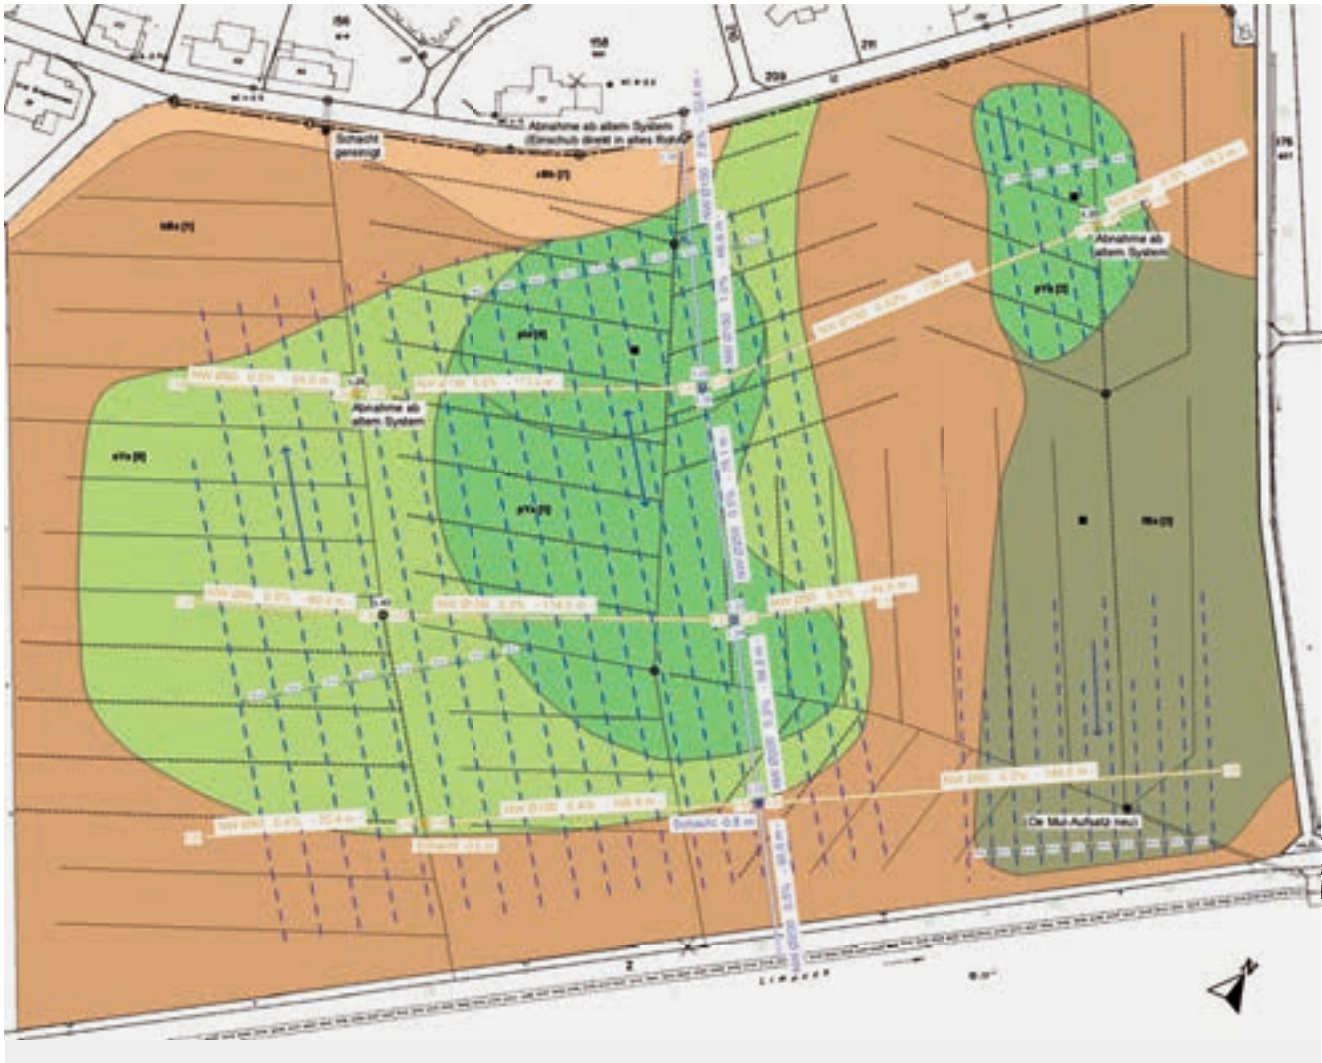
Wasserhaushaltskarte mit Ausführungsplan zur Sanierung der Entwässerung im Gebiet «Moos» in Aetingen. Grün: stauwasserbeeinflusste und stauwassergeprägte Böden; braun: normal durchlässige Böden; schwarze Vierecke: Standorte der Bodenprofile; blau gestrichelte Linien: neue Drainageleitungen; beige Linien: neue Sammelleitungen; schwarze Linien: bestehende, funktionierende Drainagen; schwarze, durchgestrichene Linien: nicht mehr funktionstüchtige alte Drainagen. Emch, 2003
